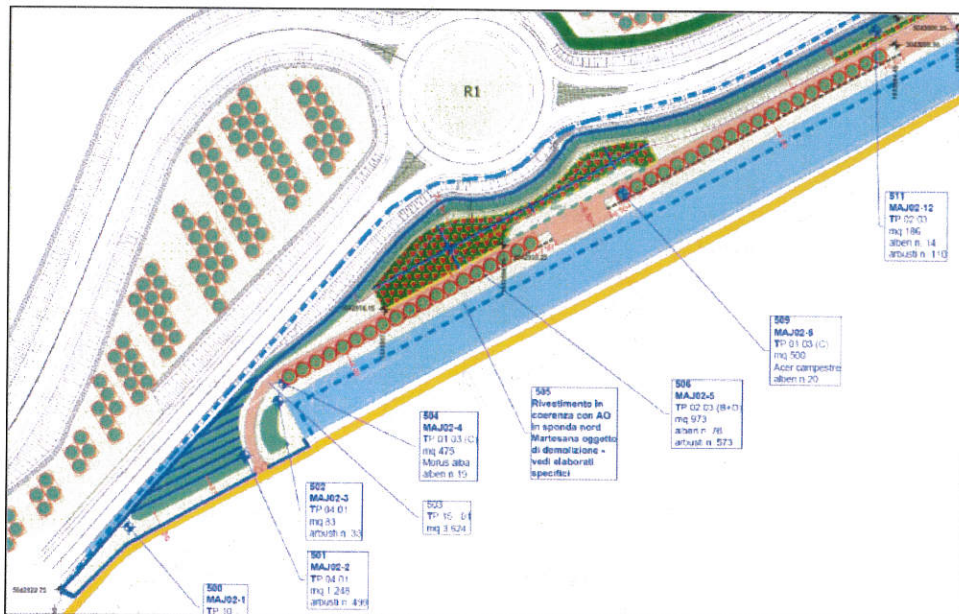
MODIFICA TECNICA- STRALCIO PLANIMETRICO INTERVENTO (LATO GORGONZOLA)
